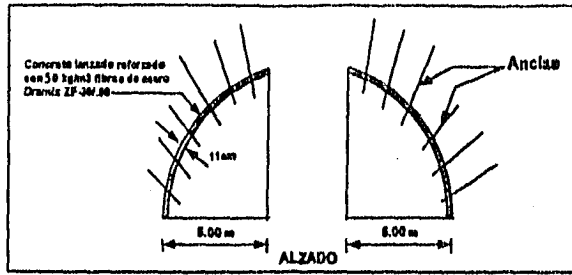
Continuar con la colocación del concreto lanzado reforzado con fibras de acero en la sección recién excavada.
